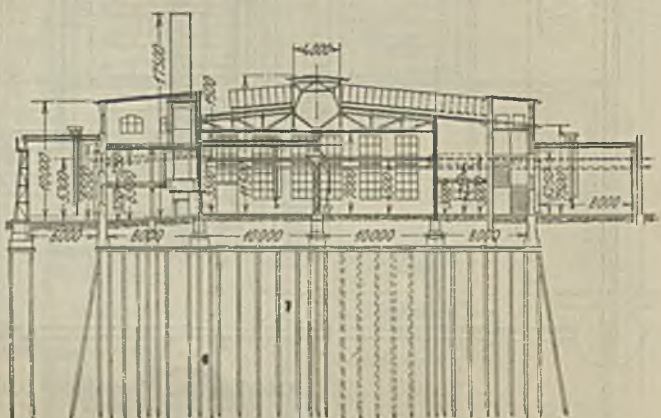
Profil einer vierschiffigen Gießerei mit äußeren Umrissen eines Dreihallenbaues.
